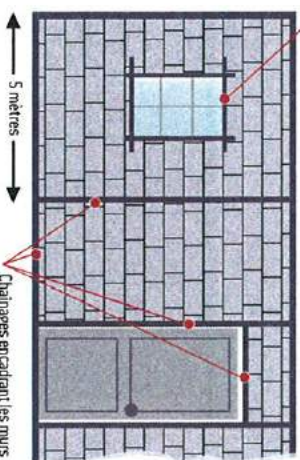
Ajout de chaînages horizontaux et verticaux encadrant les maçonneries (élévation)
